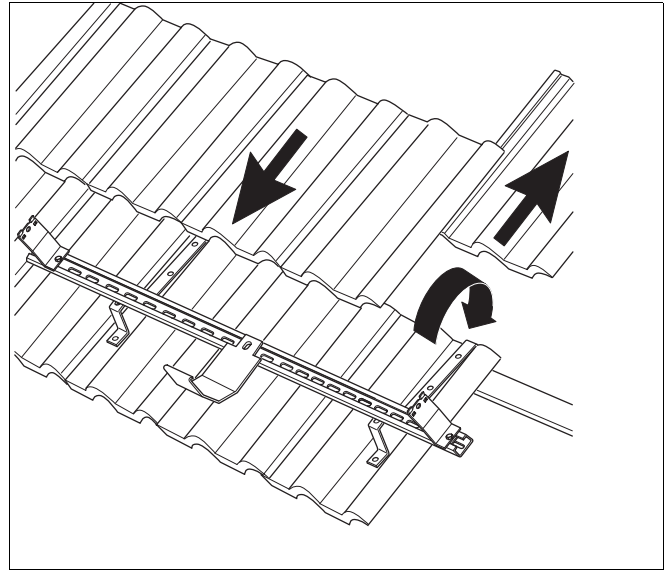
Vormontierte Konstruktion an der Dachlatte einhängen
